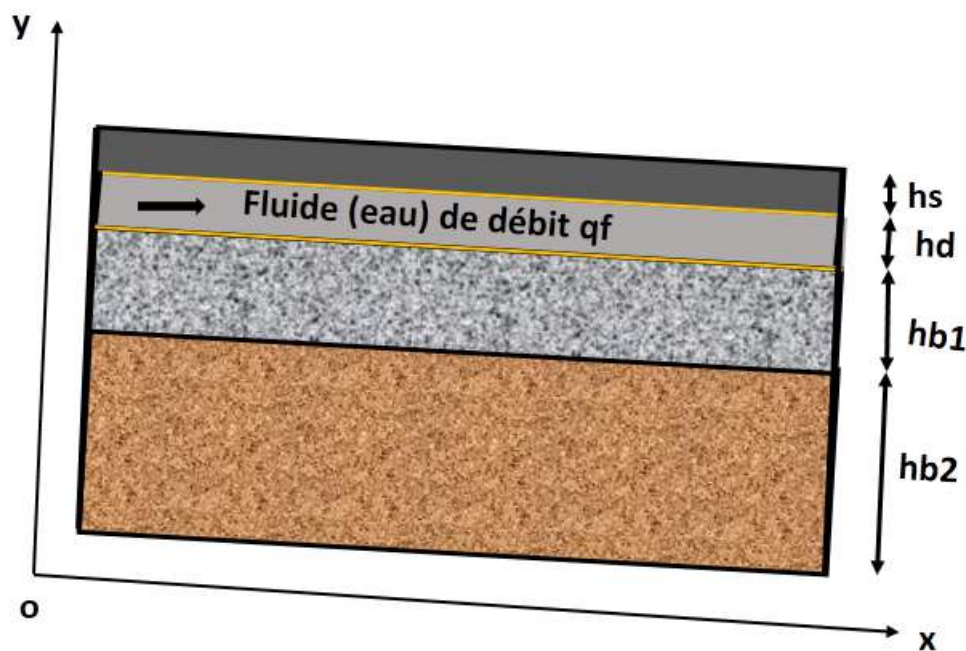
La chaussée avec ses différentes couches (coupe transversale)
